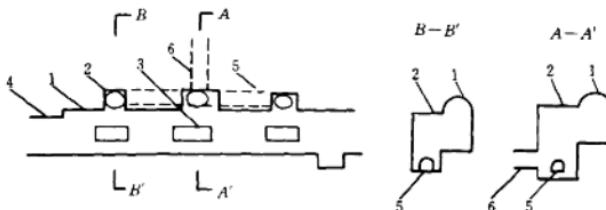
那龙煤矿二号井原设计井下水泵房平面剖面图
